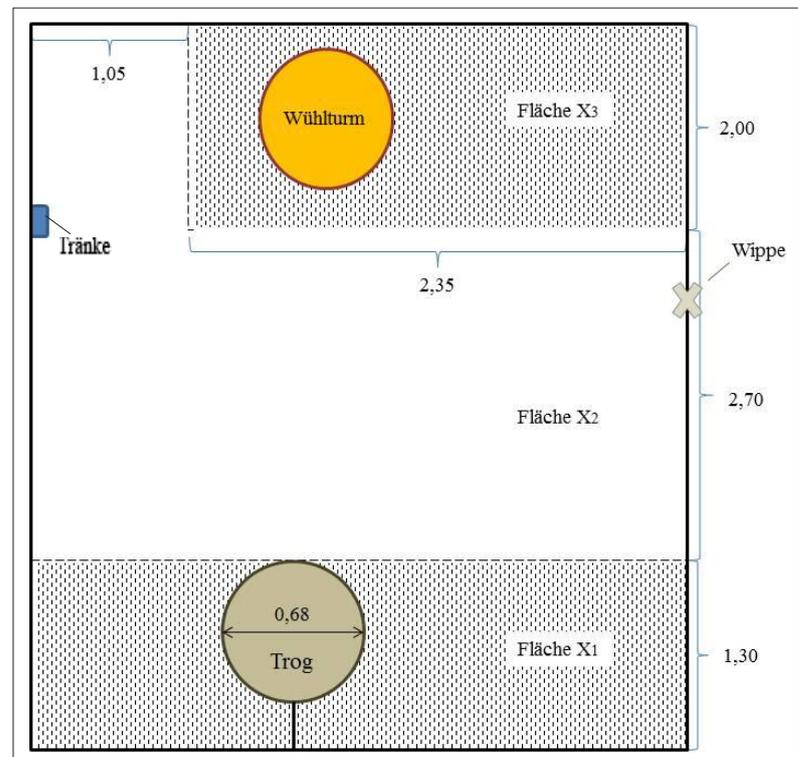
Zweiflächenbucht Mast (Laufbereiche X1 und X3 Gussroste; Liegebereich X2 mit drainierten Betonelementen)
